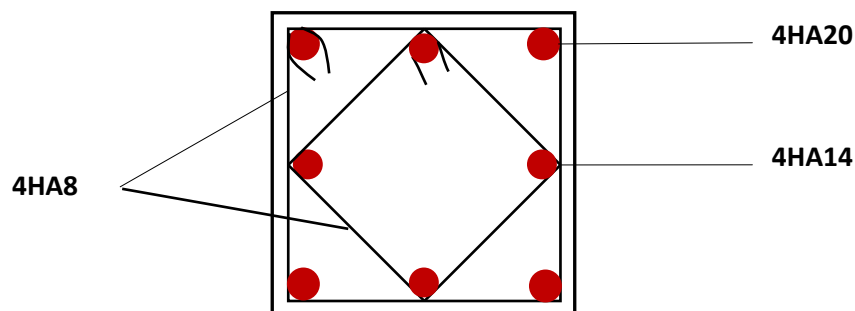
Schéma de ferrailage du poteau 45x45.
